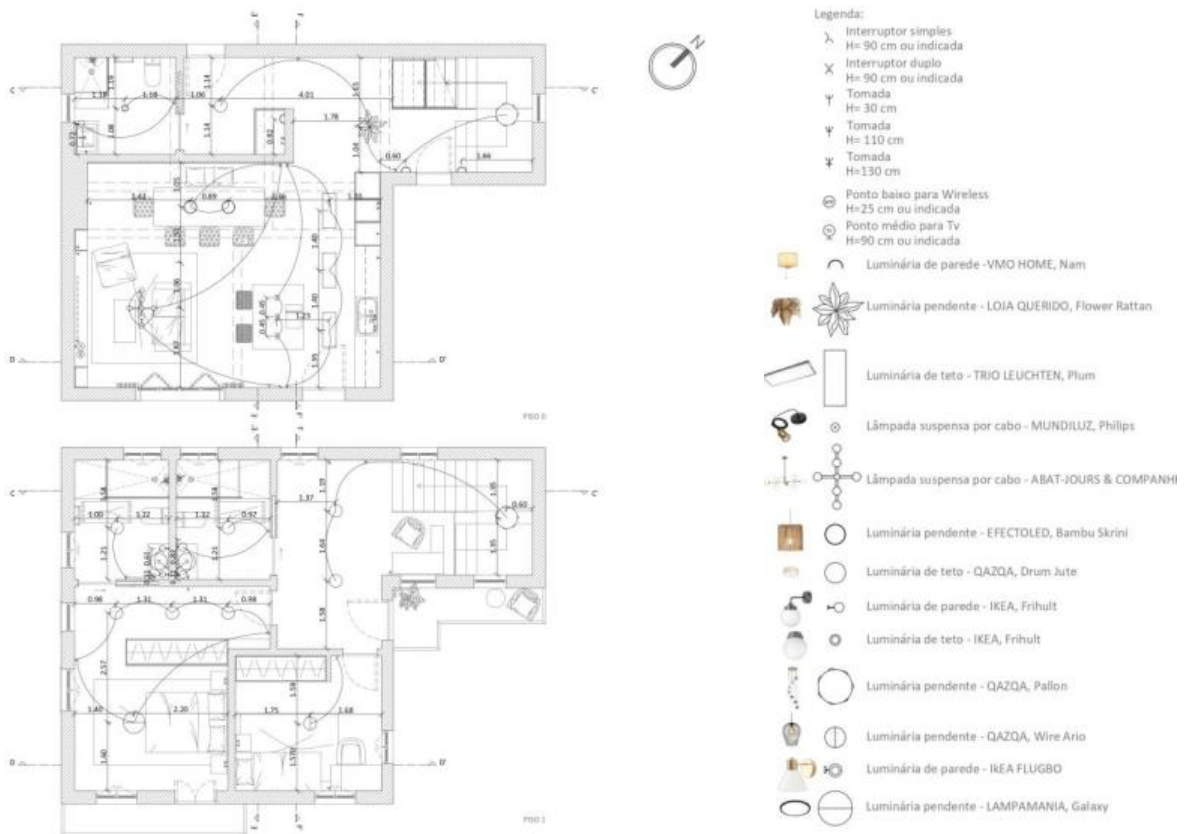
Planta de Iluminação, Piso 0 e Piso 1. Fonte: Autor
